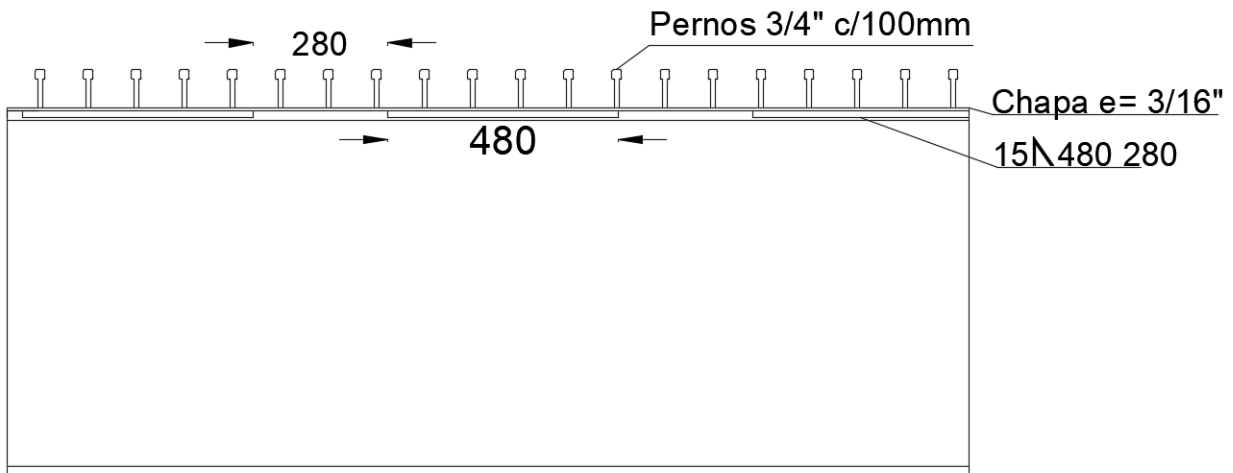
Vista lateral de la viga longitudinal central con la placa para conexión con el tablero en el ala superior.
